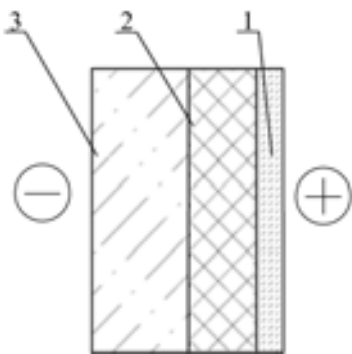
Конструкция наружной стены, утепленной монолитным пенобетоном:
